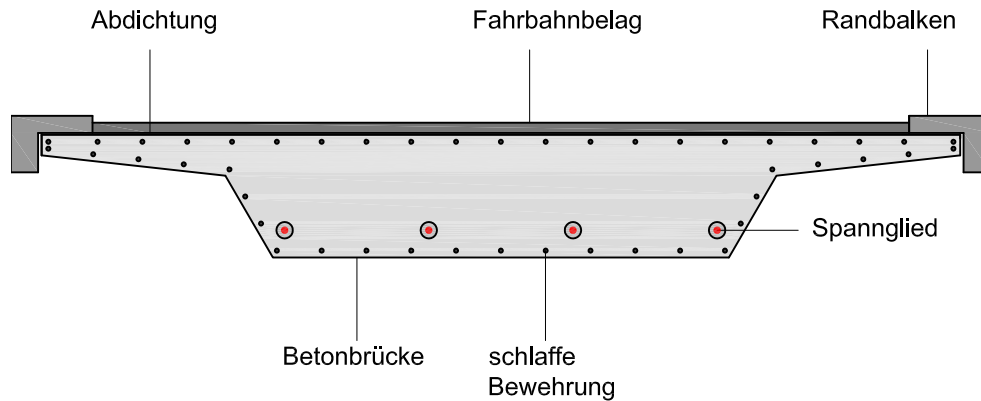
Querschnitt einer vorgespannten Betonbrücke mit Betonstahlbewehrung, Abdichtung und Fahrbahnbelag
